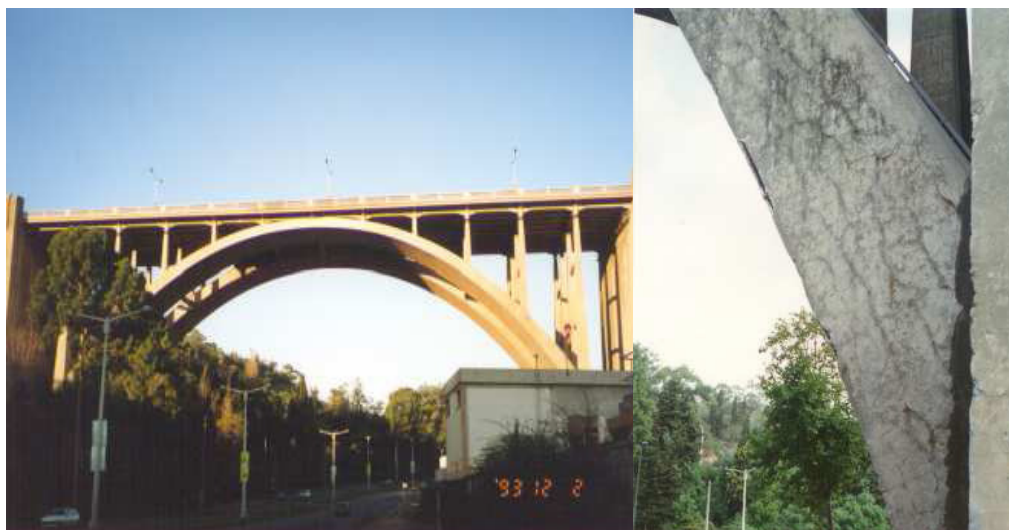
Viaduto Duarte Pacheco e sinais de fissuração num elemento estrutural
